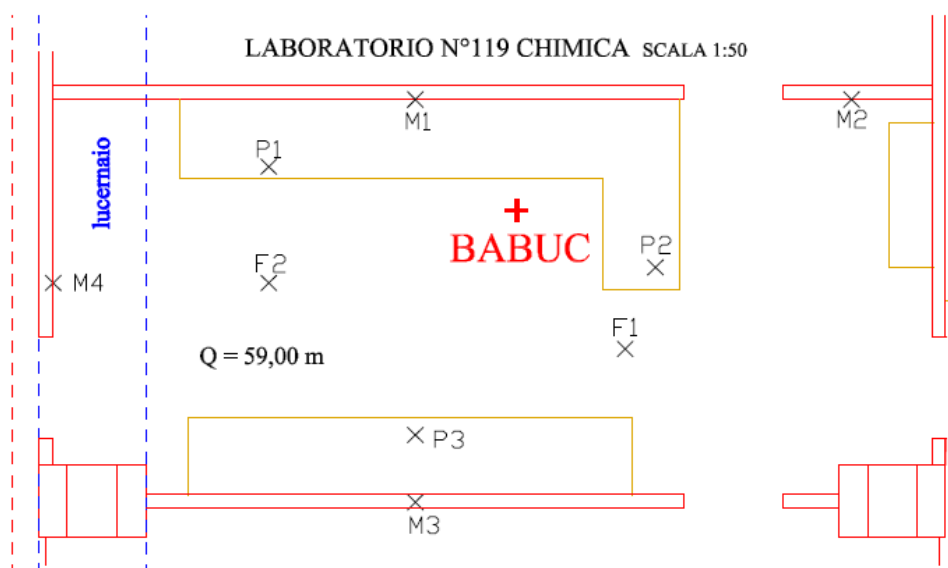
Laboratorio n°119, collocazione in pianta dei punti di misura
